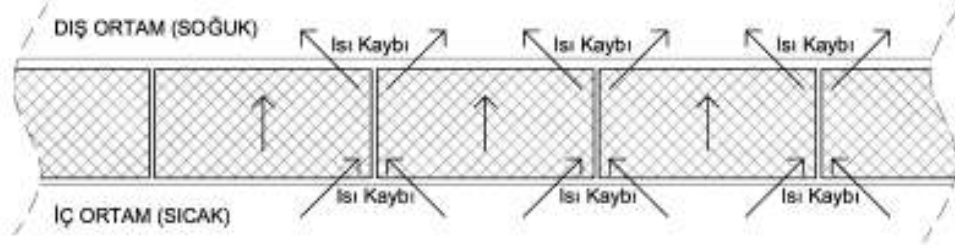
İtten yapılan ısı yalıtım çözümlerinde kullanılan su ve ısı yalıtımı
